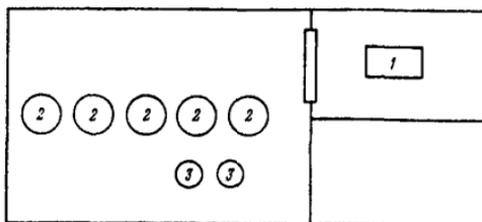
Планировка зоны обслуживания компрессорных установок:
